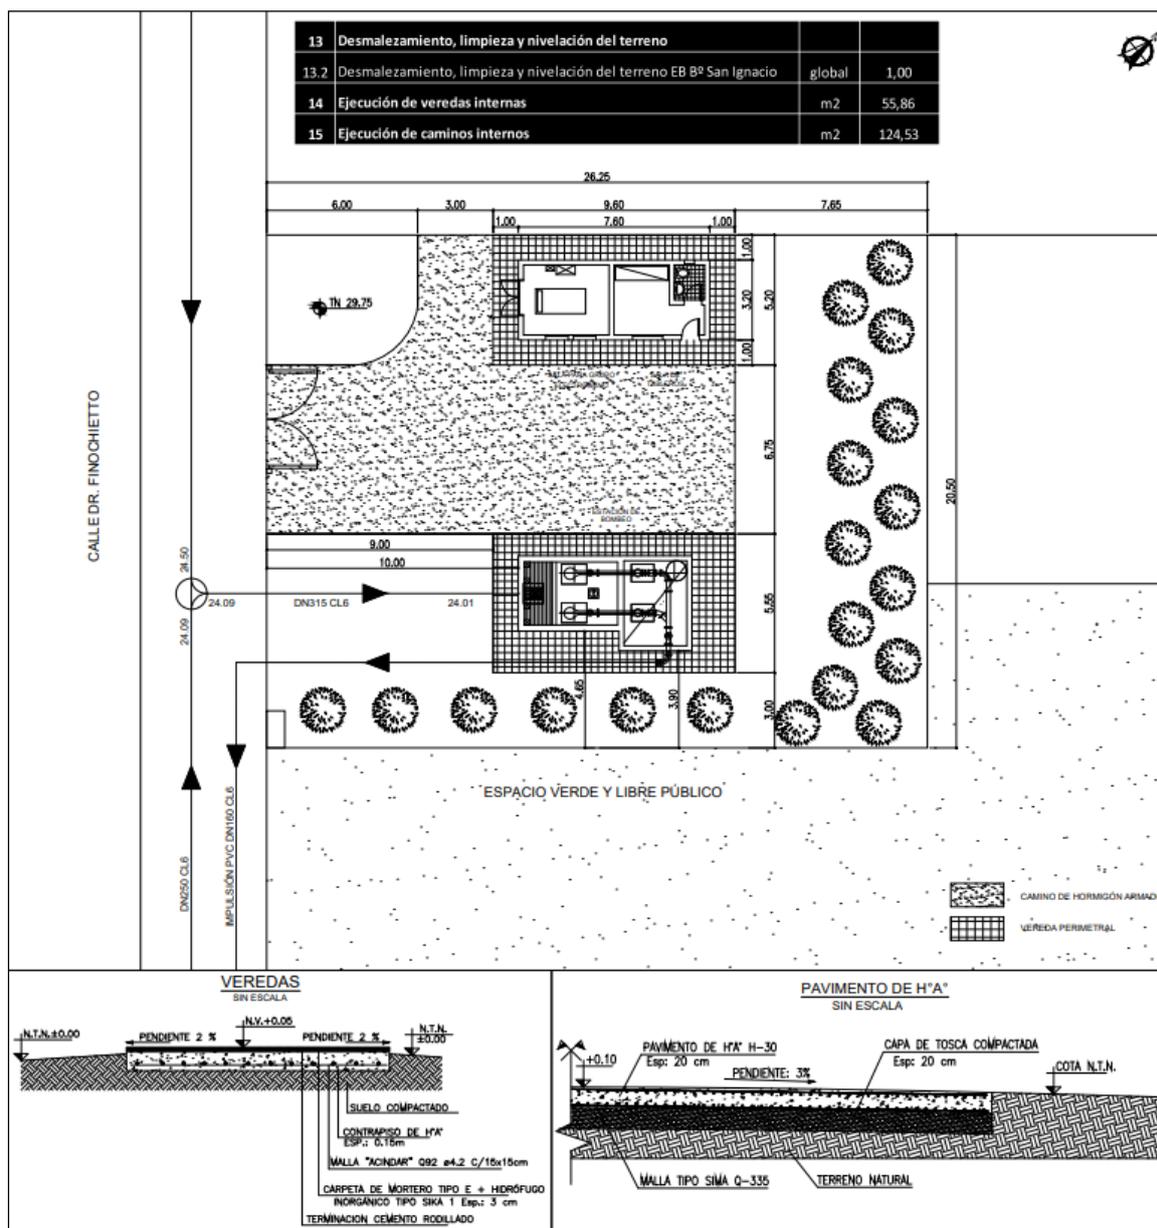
Plano de pavimento y veredas internas a ejecutar en Estación de bombeo 2, barrio San Ignacio (EEB 2).
